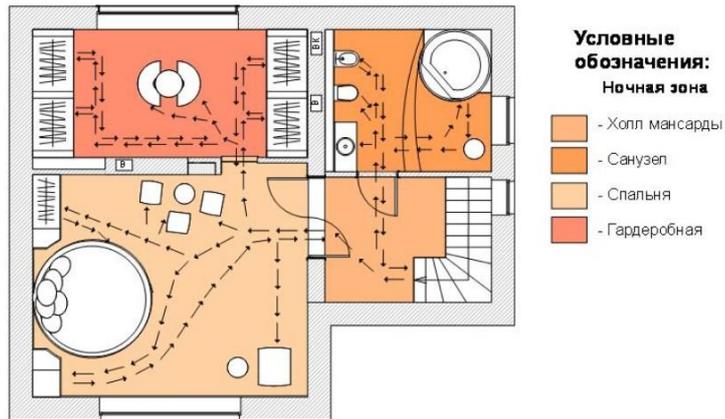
Пример схемы транзитных путей по схеме функционального зонирования квартиры
